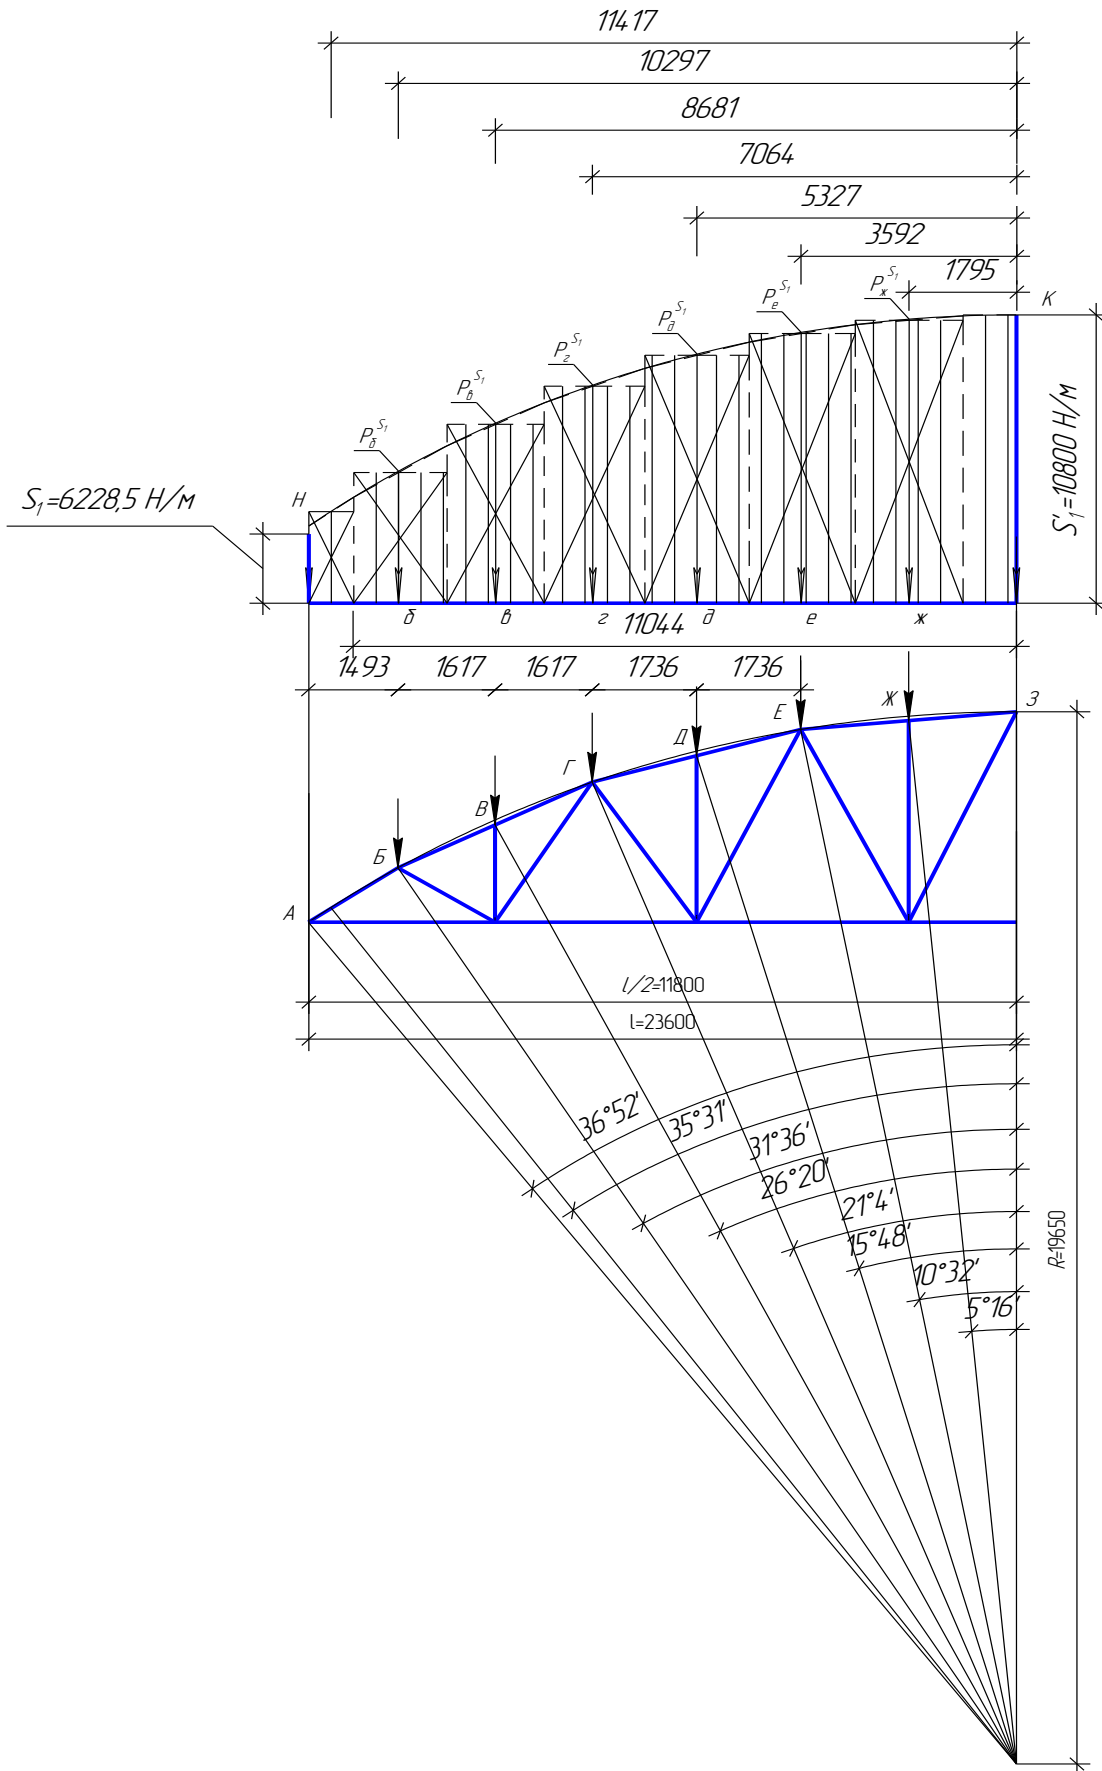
Схема определения узловых нагрузок от снега, распределенного по косинусоидальной эпюре
